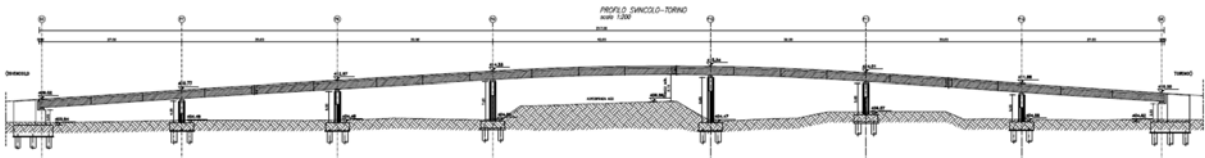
Sovrappasso di ingresso - profilo longitudinale
